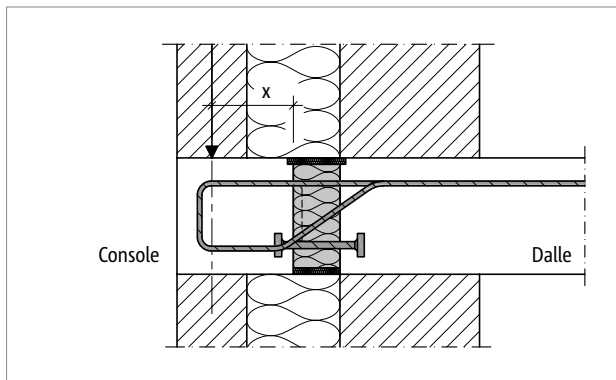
Schöck Isokorb® T type O : console avec maçonnerie de parement
